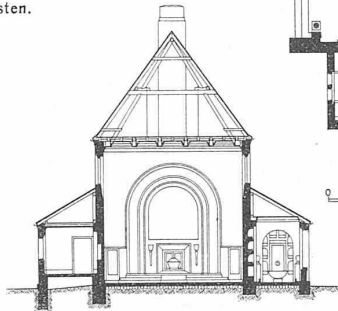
bis 4. Grundriss und Schnitt. 1:400.
